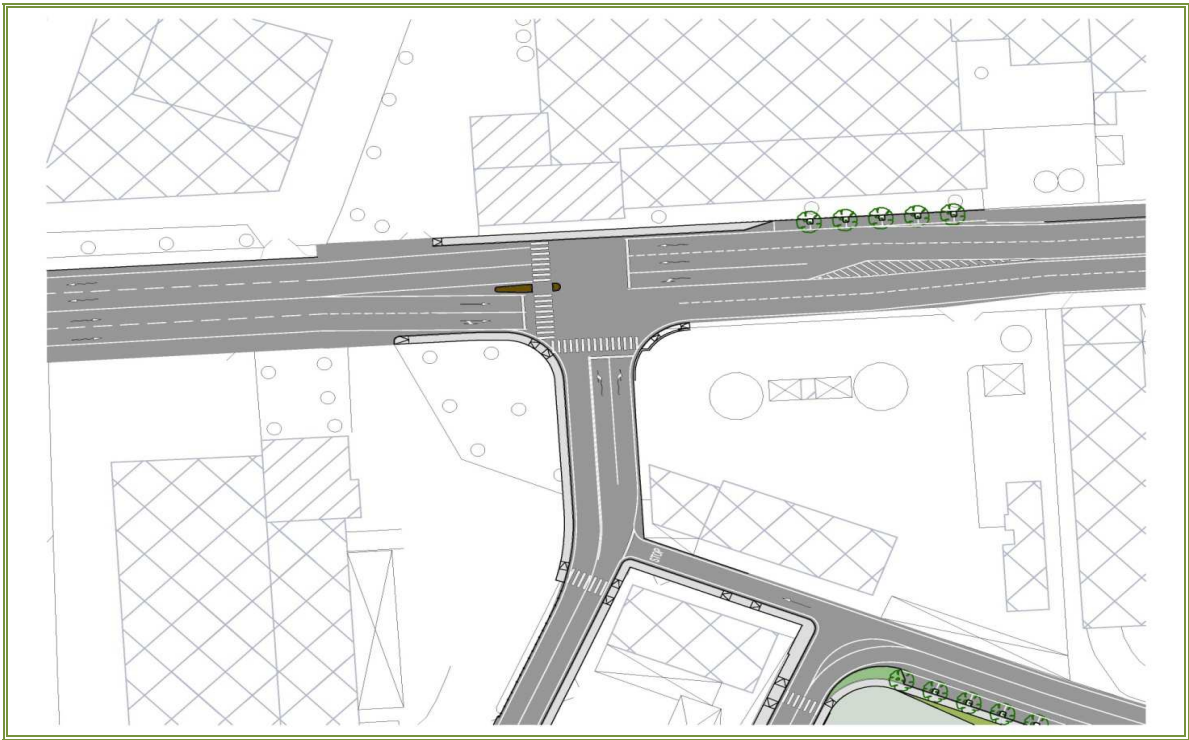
Planimetria Svincolo Vigasio Nord Nodo Via Gioia – 2a Traversa
